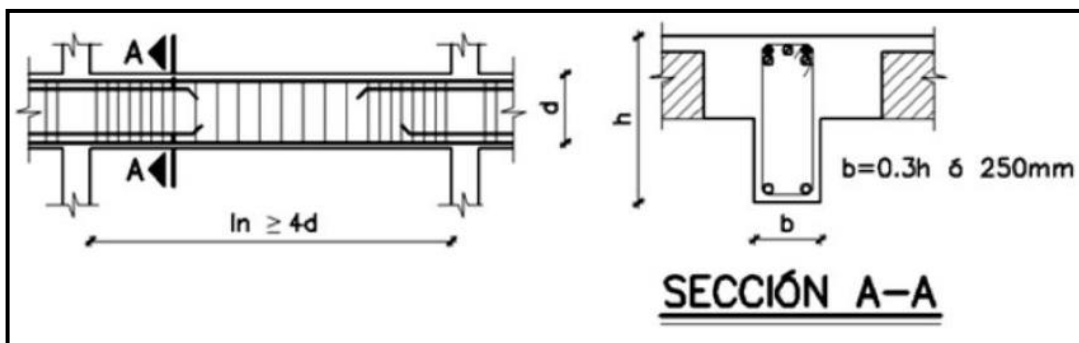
Ancho mínimo de la sección transversal de la viga
